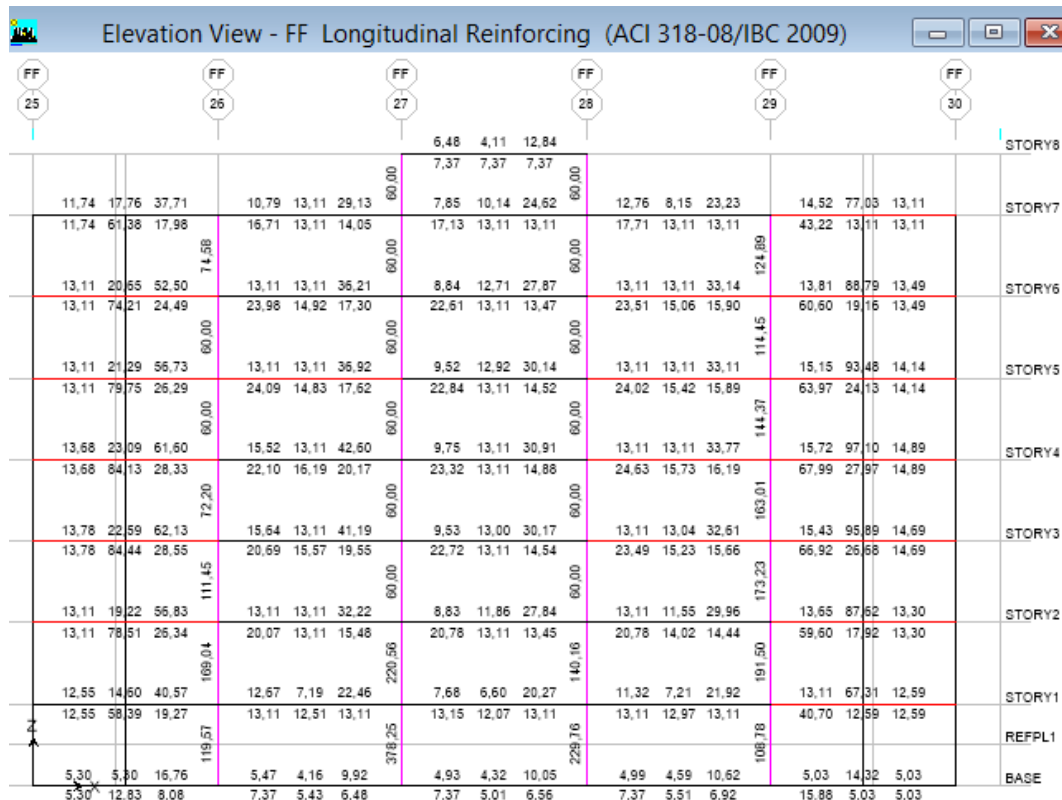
Acero en Vigas y Columnas en el Pórtico FF – Hospitalización 2- (LRB+HDR)
